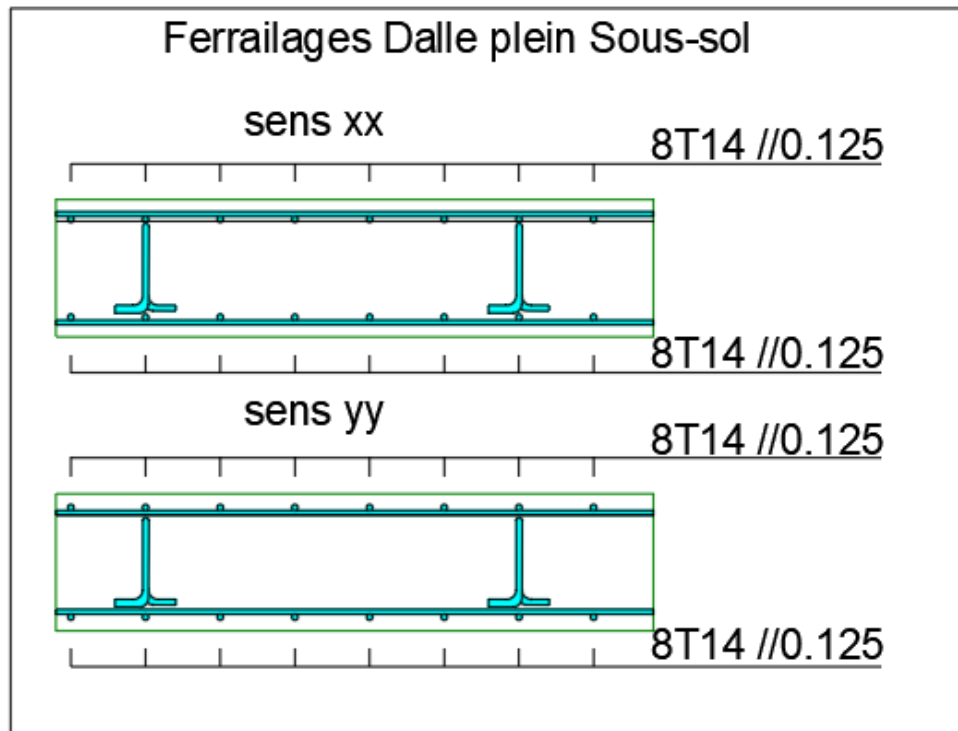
Schéma de ferrailage pour la dalle sou-soul.
